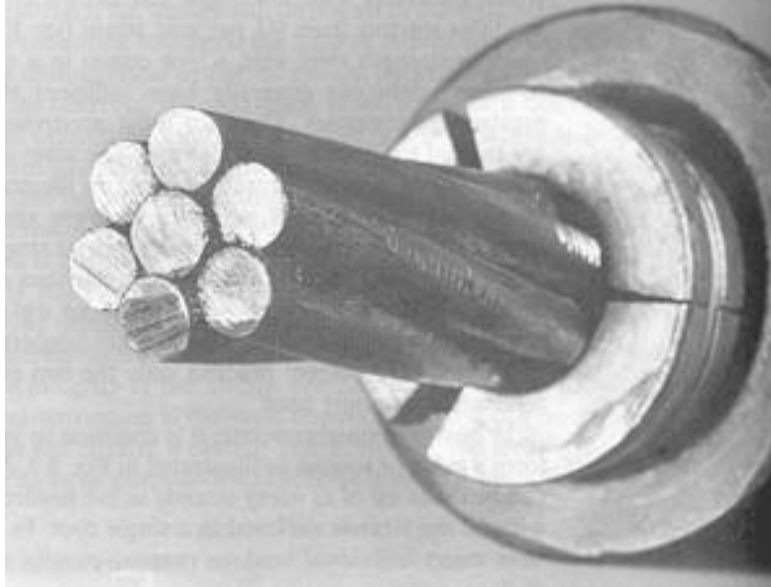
Torón utilizado en concreto presforzado (ANIPPAC, 2014).
